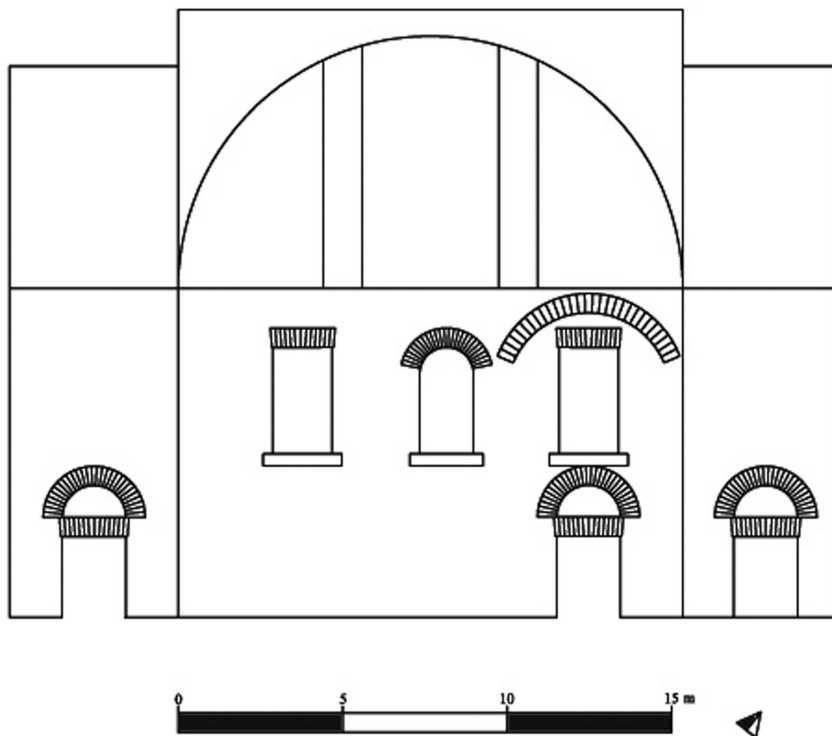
Prospetto ricostruttivo della parete ovest dell'ambiente 4
